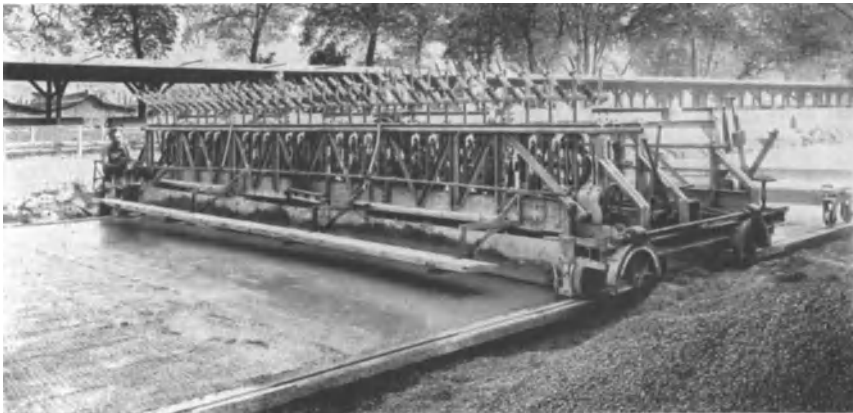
Stampfmaschine zur Verdichtung von Betonstraßen mit Stempeln. System: Dingler, Zweibrücken.
